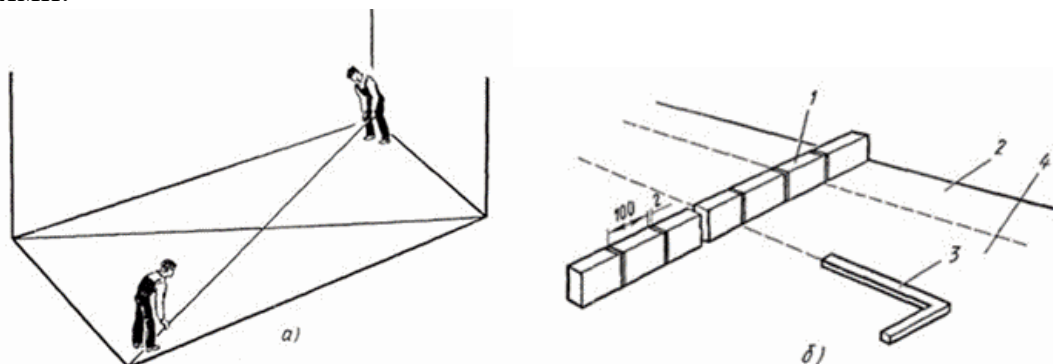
Разбивка прямоугольного покрытия пола:
